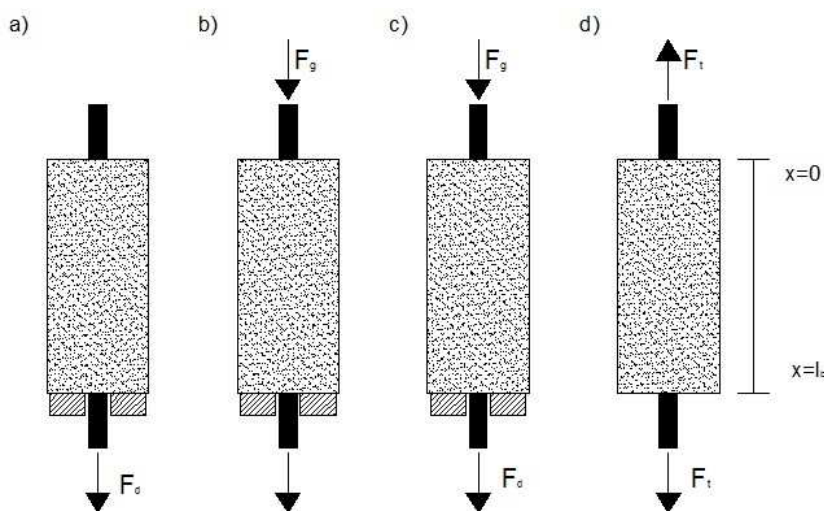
Modele badań: a) „beam anchorage test”, b) „beam splice test”
